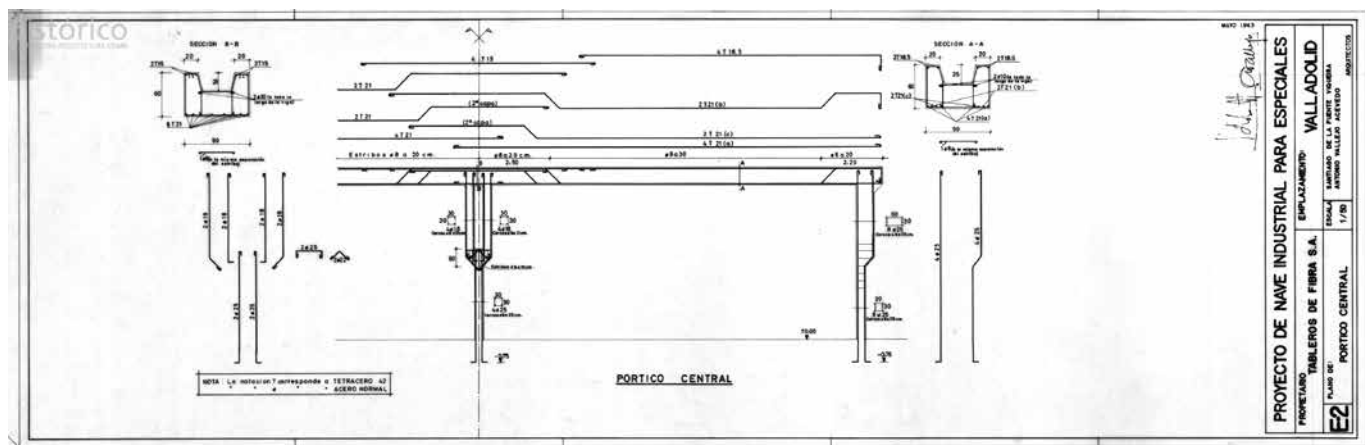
Nave de Tableros Especiales. Plano de detalles de estructura.
